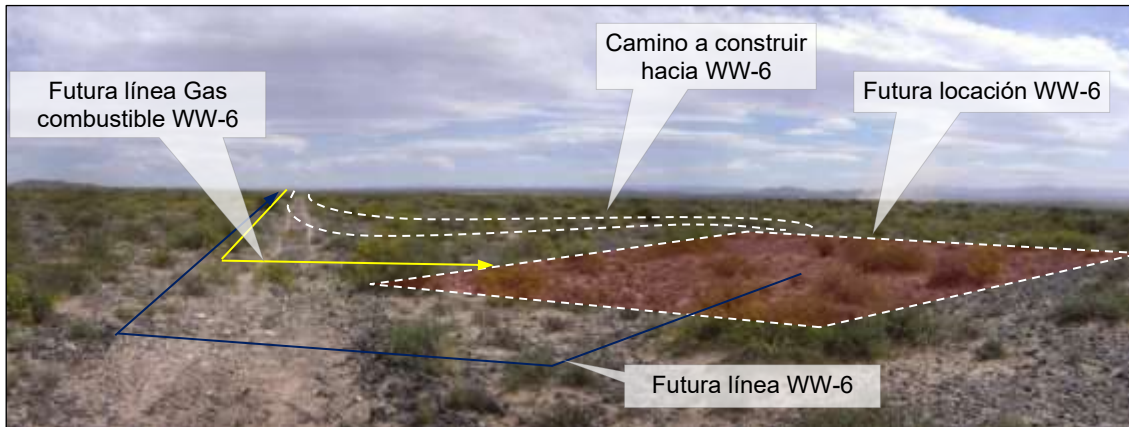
Vista en dirección Suroeste. Se observa el predio del futuro pozo WW-6 y el camino a construir para ingresar por el sector Oeste de la futura locación. Se aprecia en azul el inicio de la traza de la línea WW-6 y en amarillo el tramo final de la futura línea gas combustible WW-6. Coordenadas x: 5834534; y:2489942.
